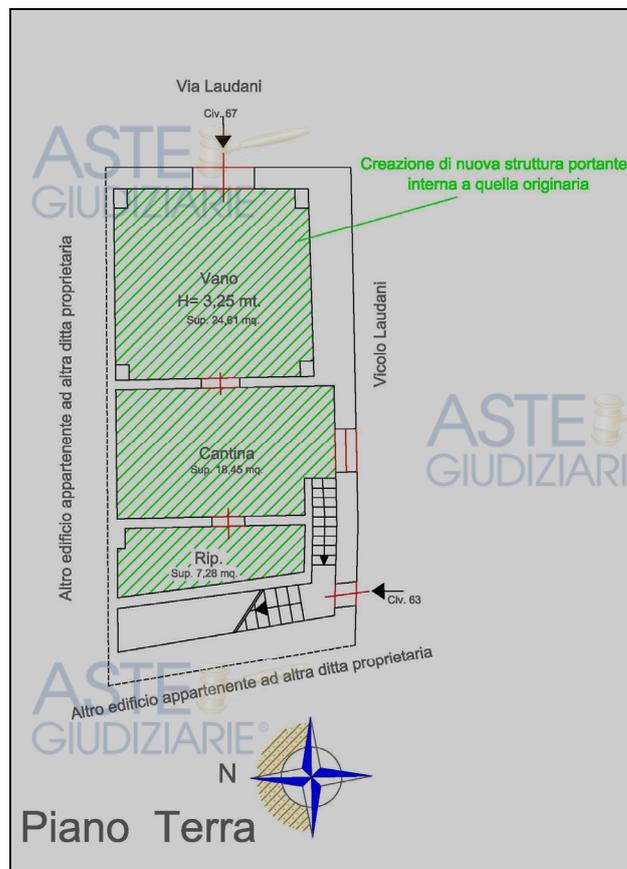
Visualizzazione della pianta planimetrica dell'immobile a piano terra con indicazione delle difformità riscontrate
